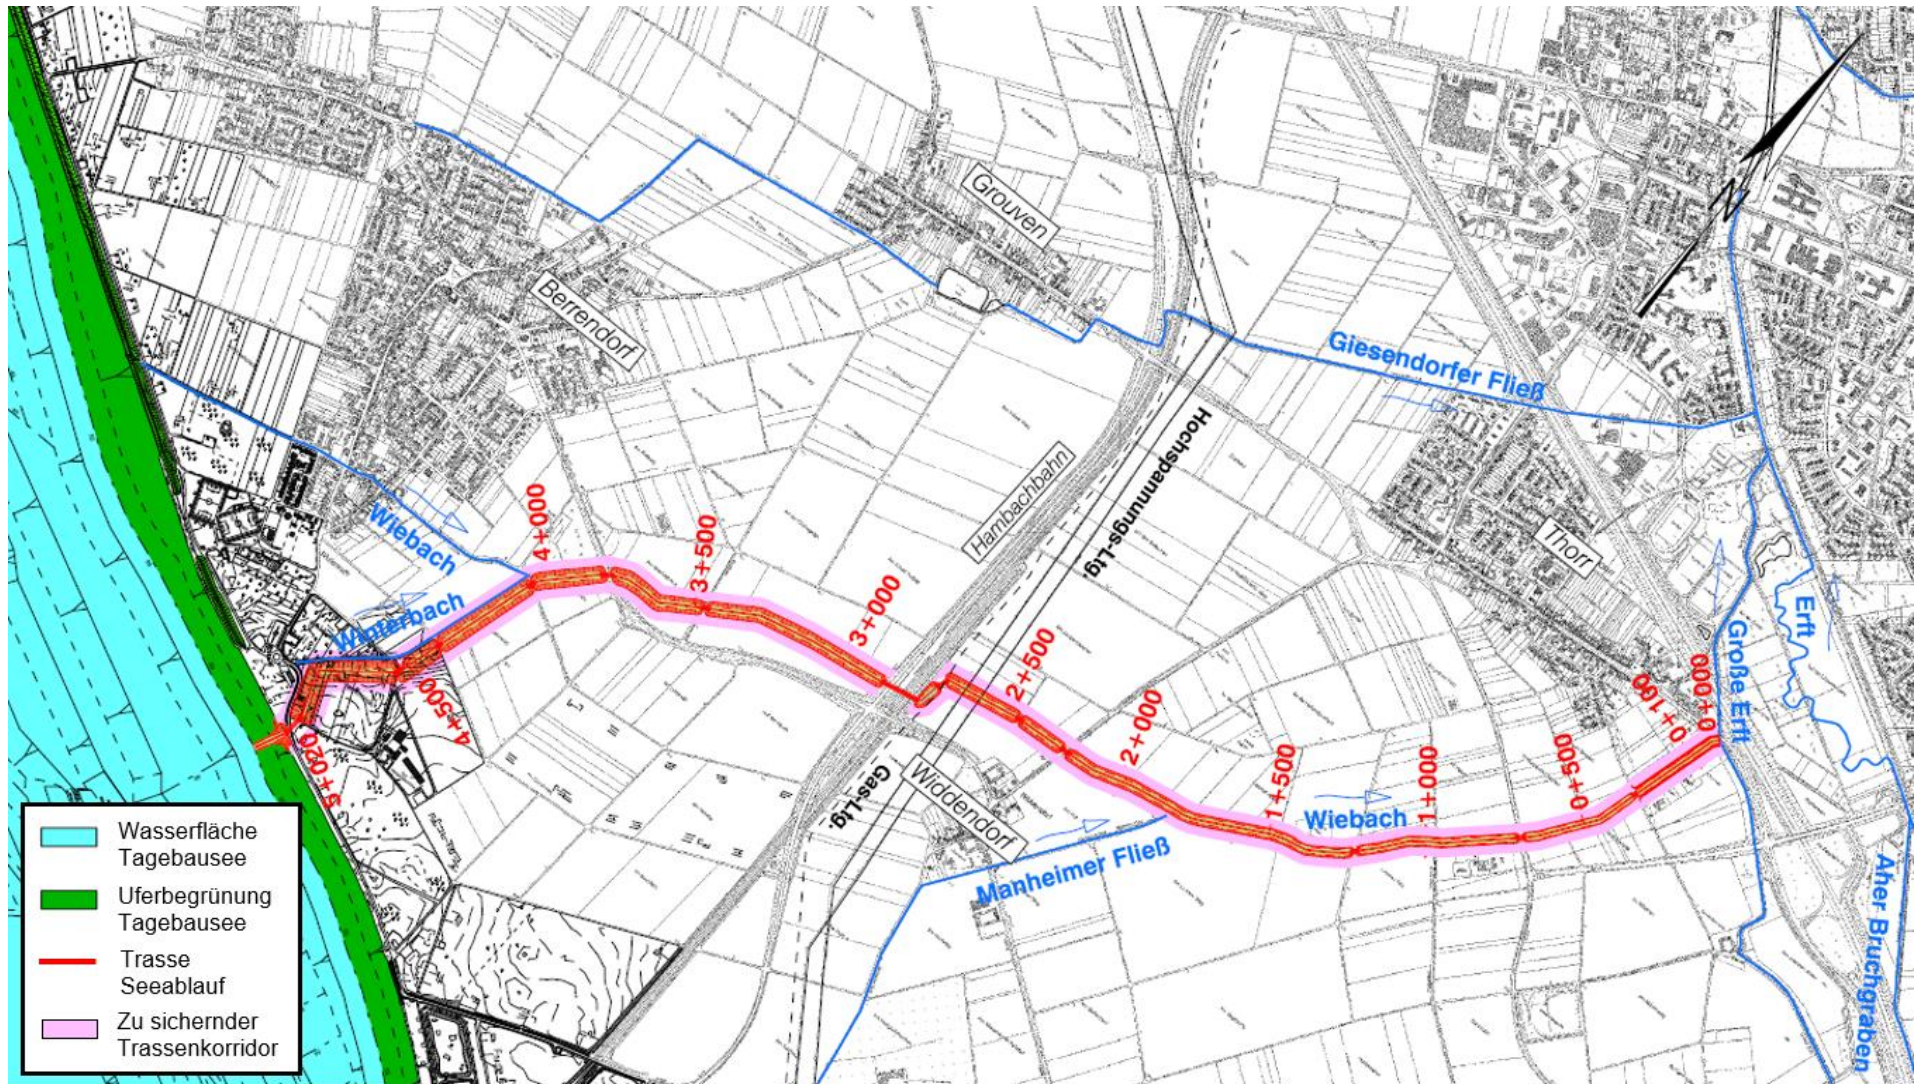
Detaildarstellung der Vorzugstrasse Wiebach für den Ablauf des Tagebausees Hambach zur Erft inklusive des zu sichernden Trassenkorridors.
